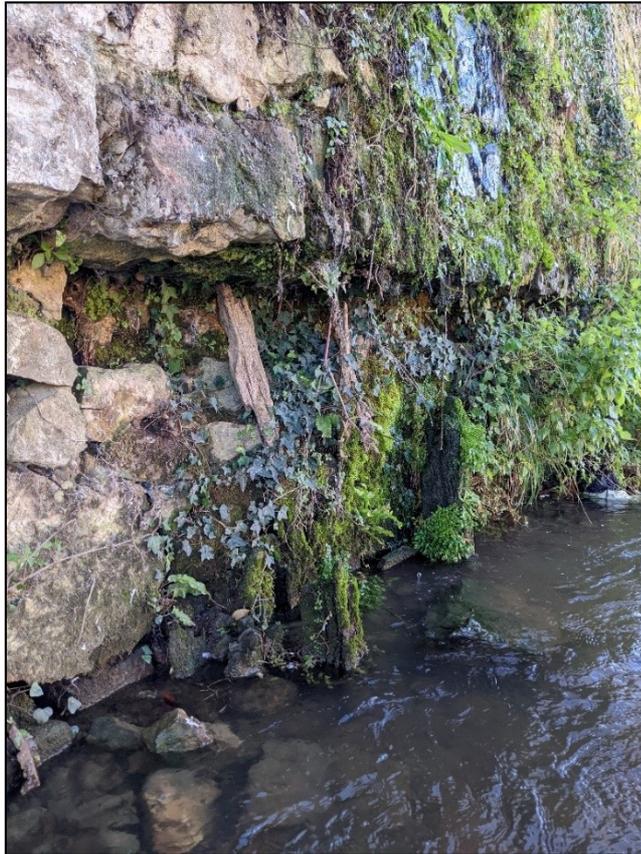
Pied du mur de soutènement aval rive gauche à reconstruire
